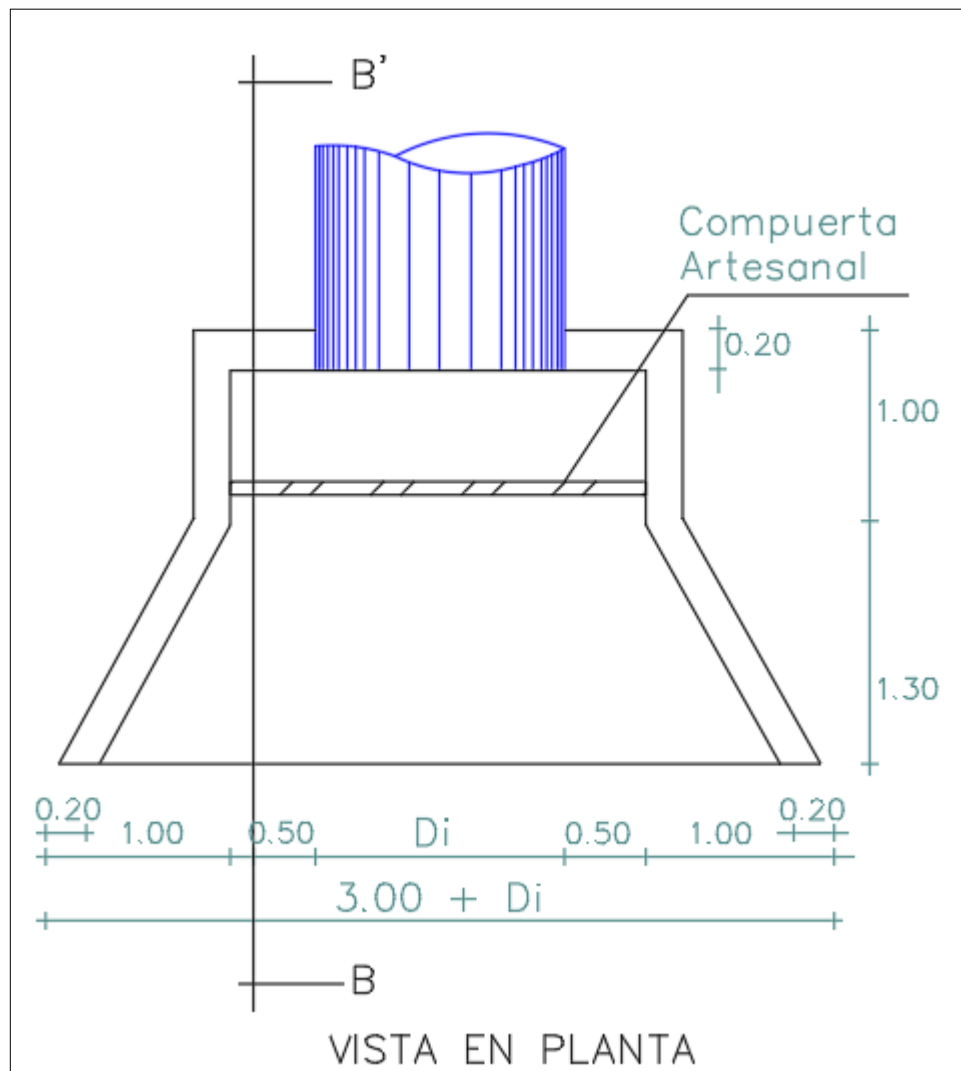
Tipo 1: Cabezal de Descarga y Muros de Ala (Vista en Planta).
